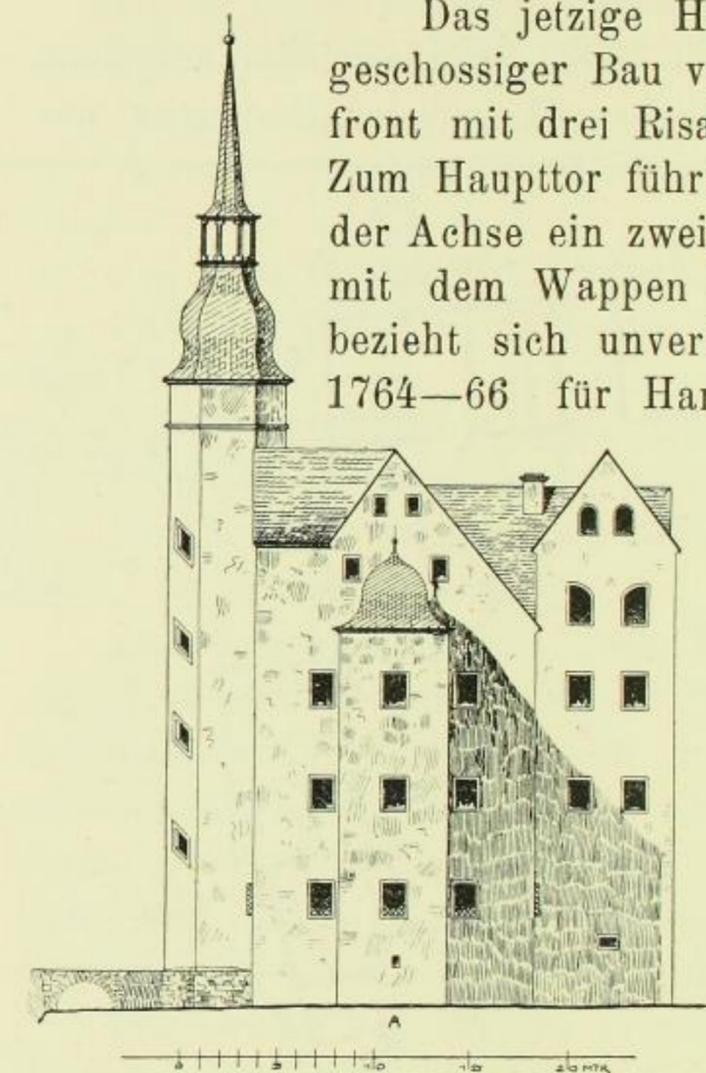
Stösitz, Schloß. Nach altem Plan.
